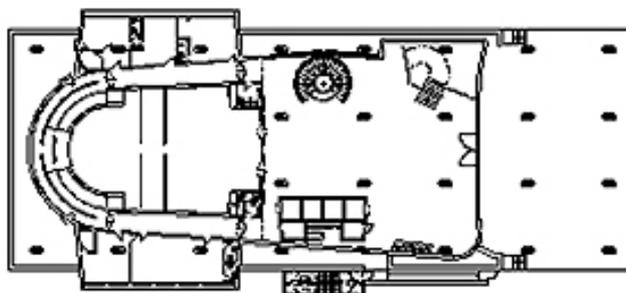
Planta baixa do térreo, indicando a descarga da escada em uma rampa até o passeio.
